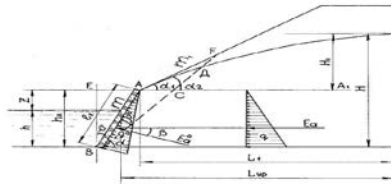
Схема к расчету давления грунта на водопроницаемую подпорную стенку
